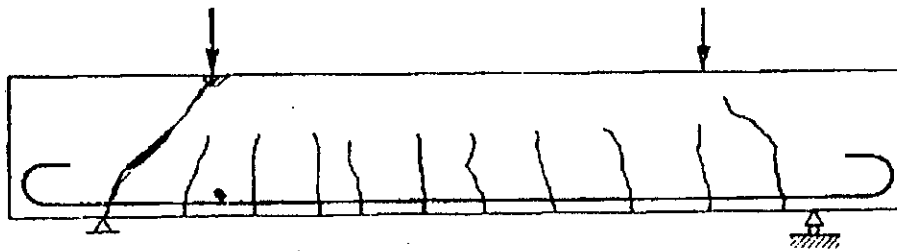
Fissuration d'une poutre mince lors de la rupture par fendage.
